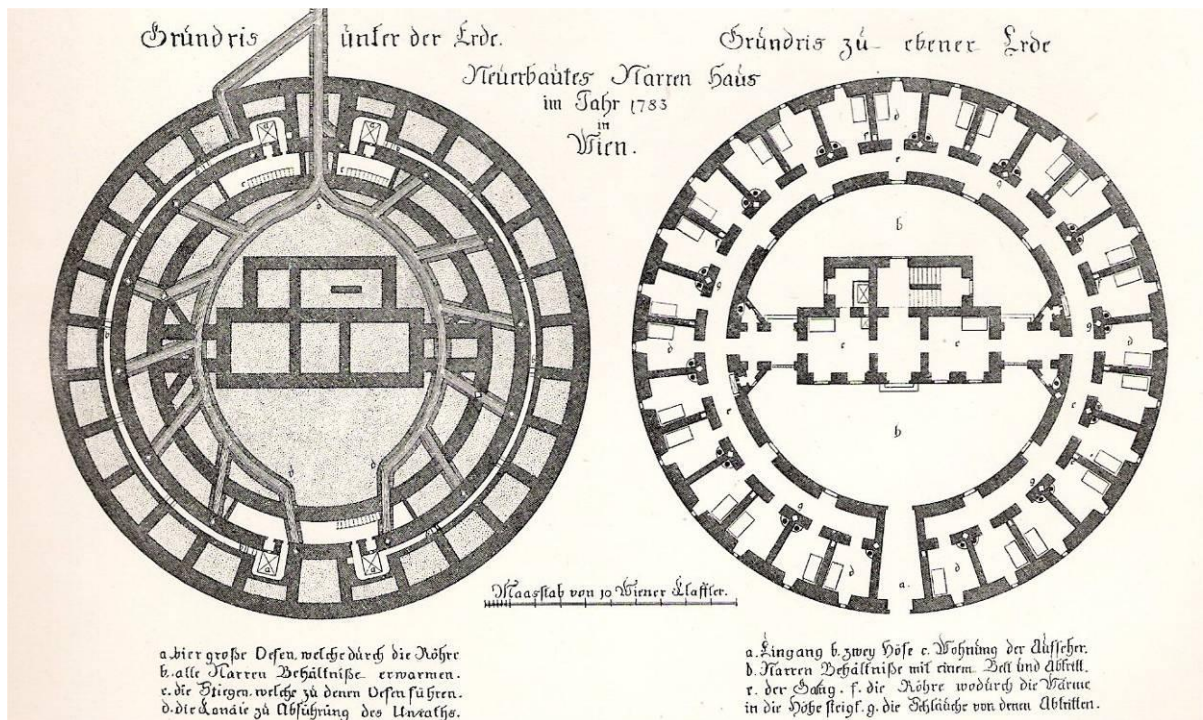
Narrenturm, Grundriss- Entwurf 1783
